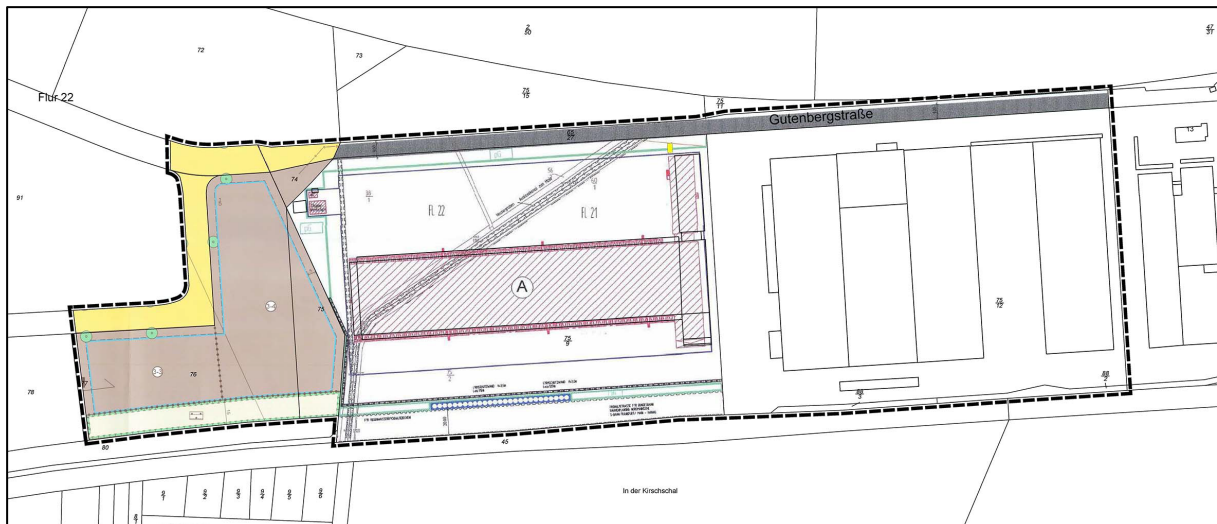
Bestehende Bebauungspläne innerhalb des Plangebietes
